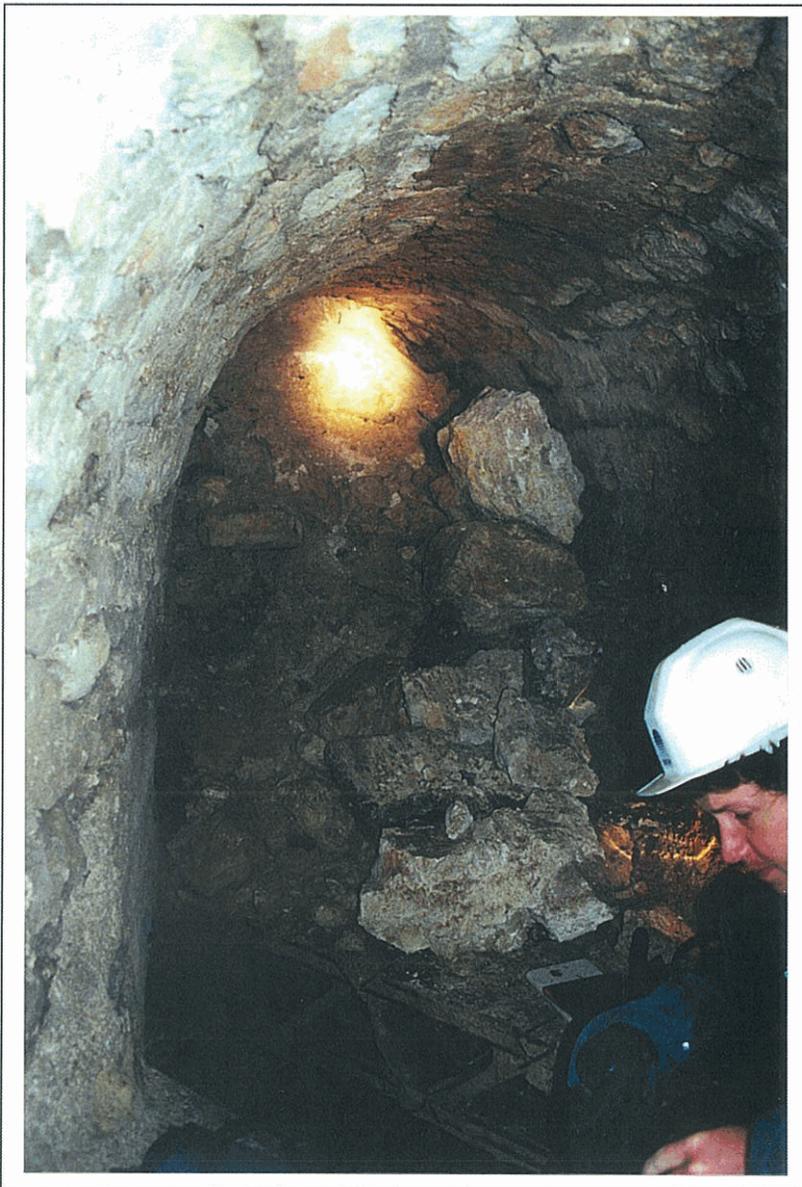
début de la galerie supérieure bouchée au sud par un effondrement.
